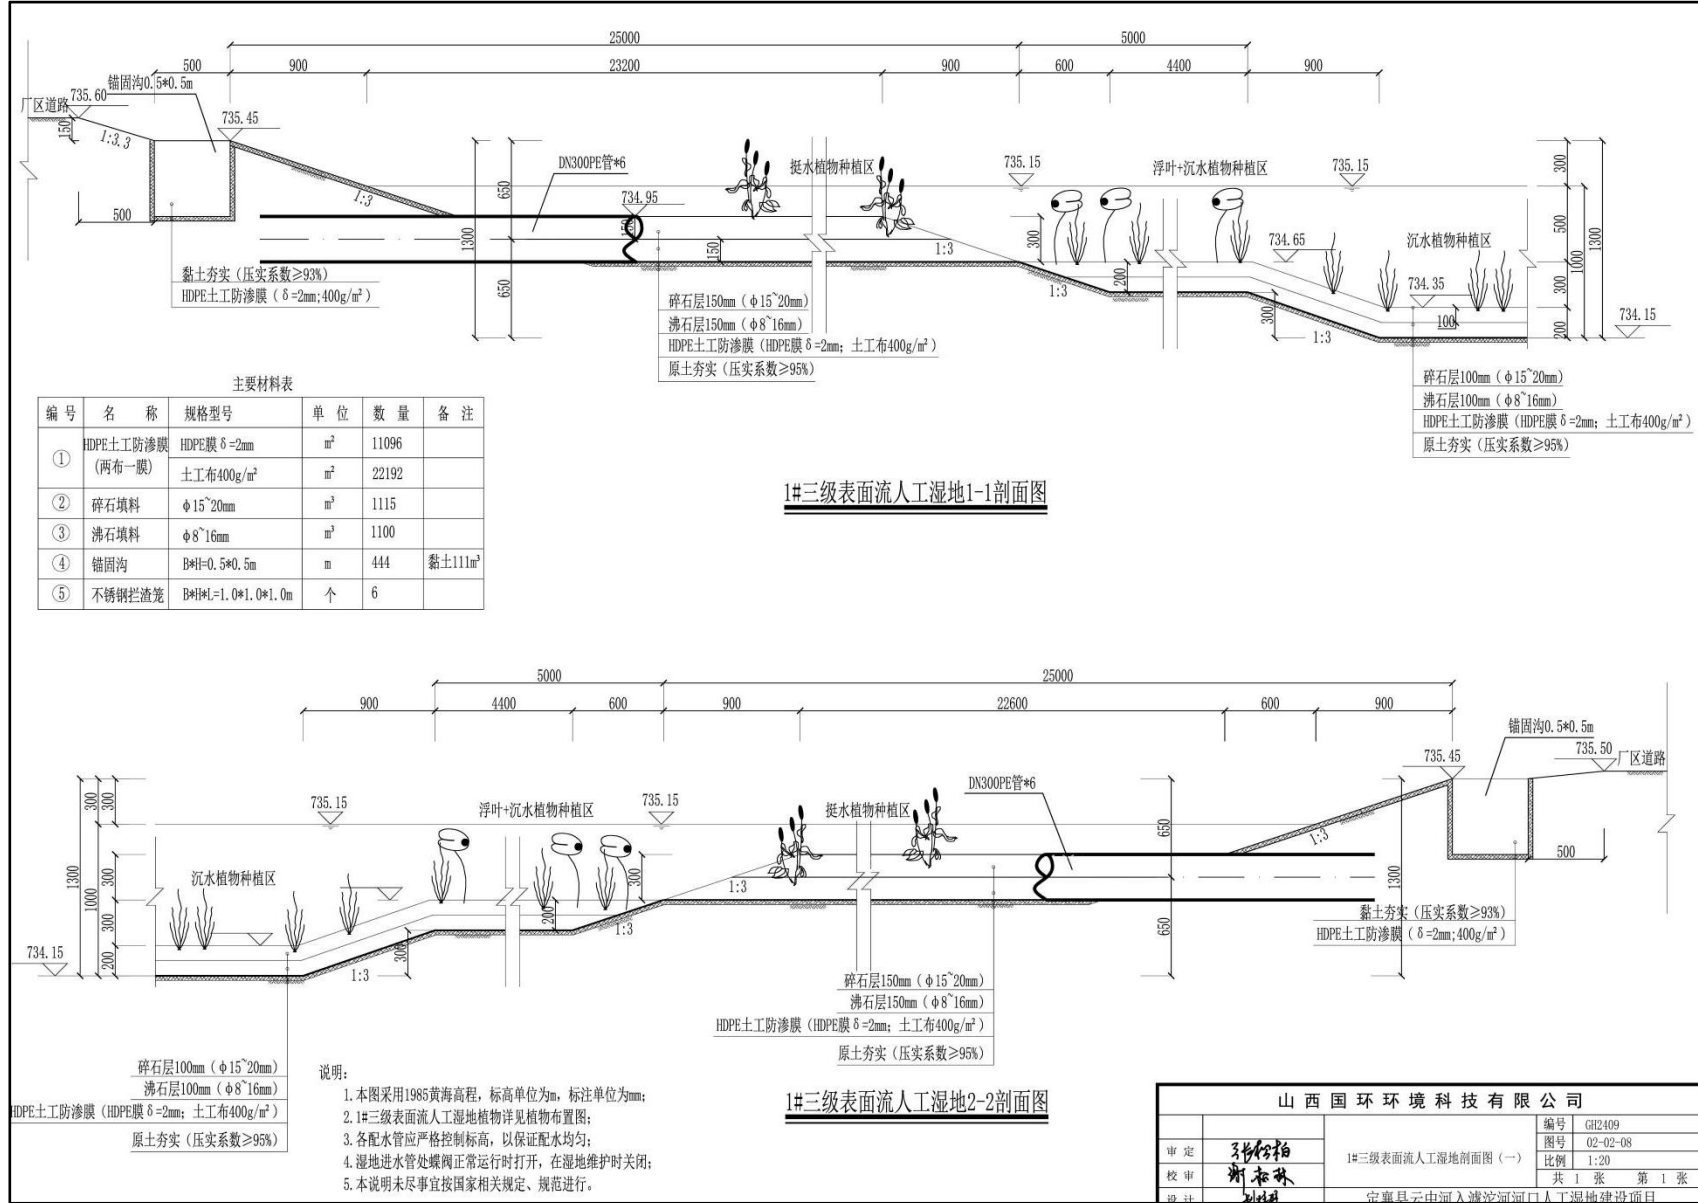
1#三级表面流人工湿地剖面图 (1)
